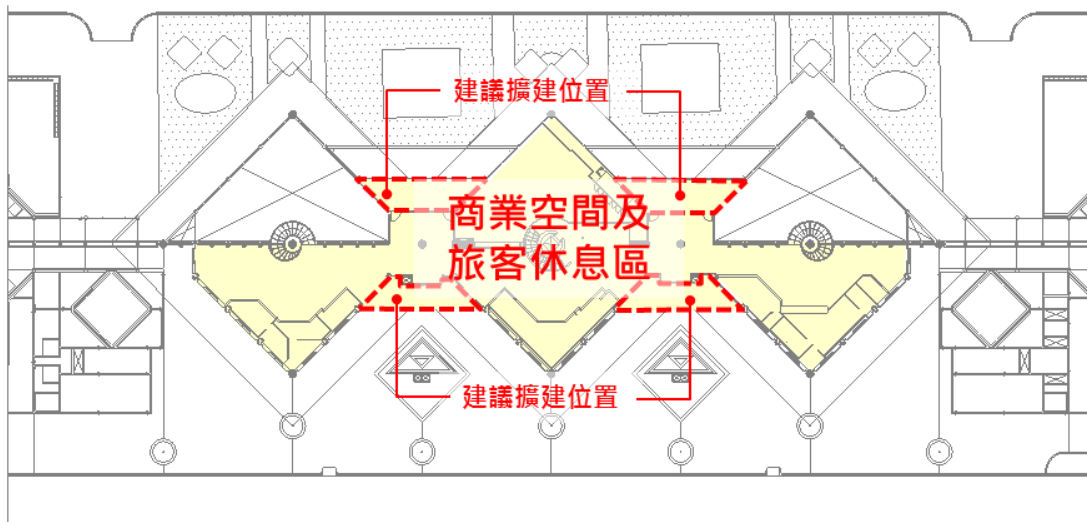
關廟服務區南下站建議增建方案二樓平面圖
